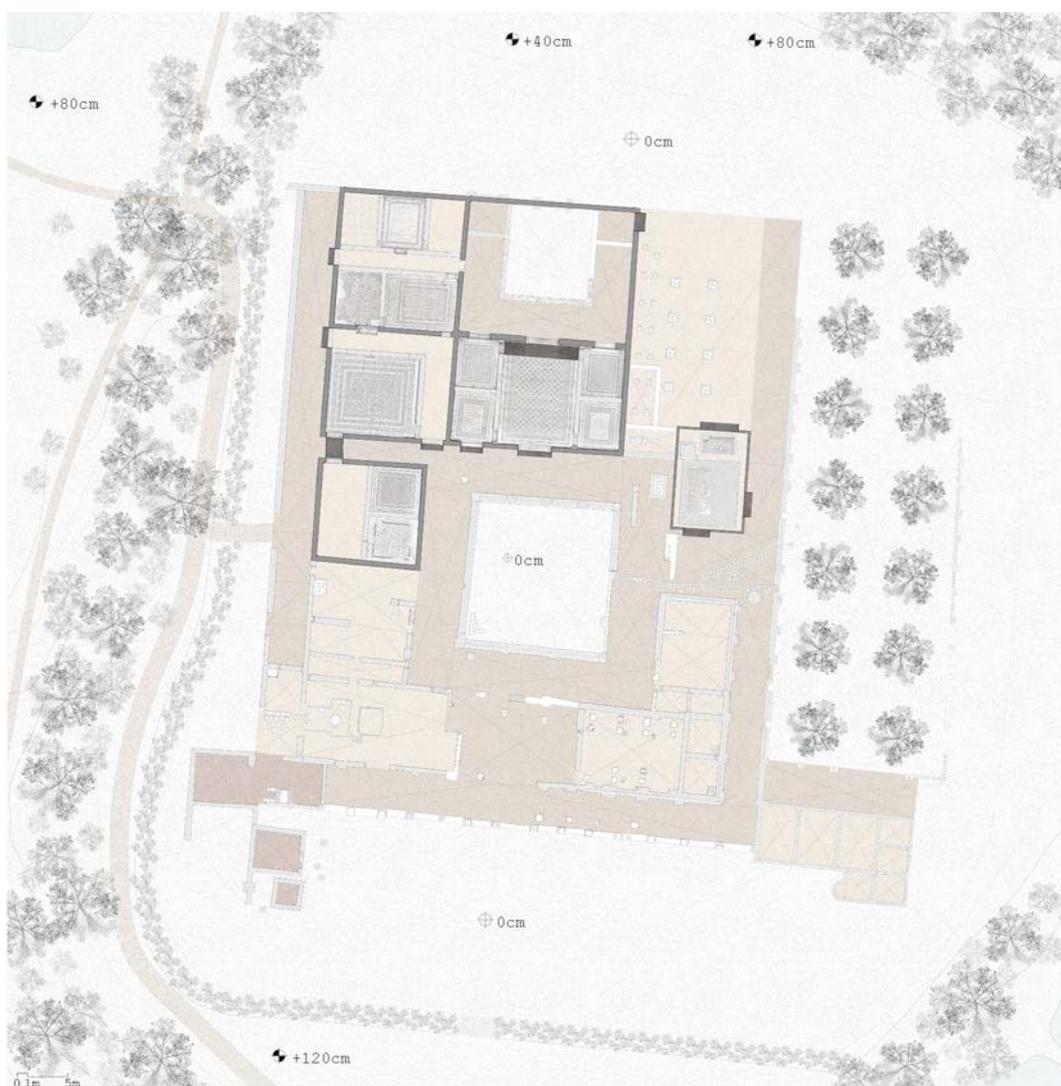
Il progetto di musealizzazione dell'area archeologica, planimetria.
